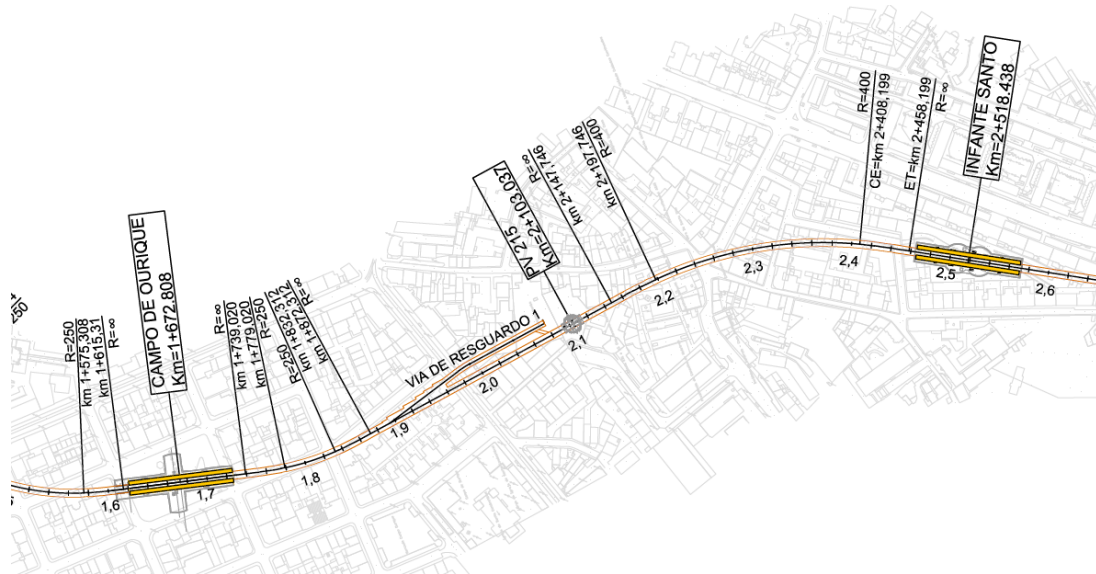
Traçado em Planta – 83.º Troço – Infante Santo – Campo de Ourique
